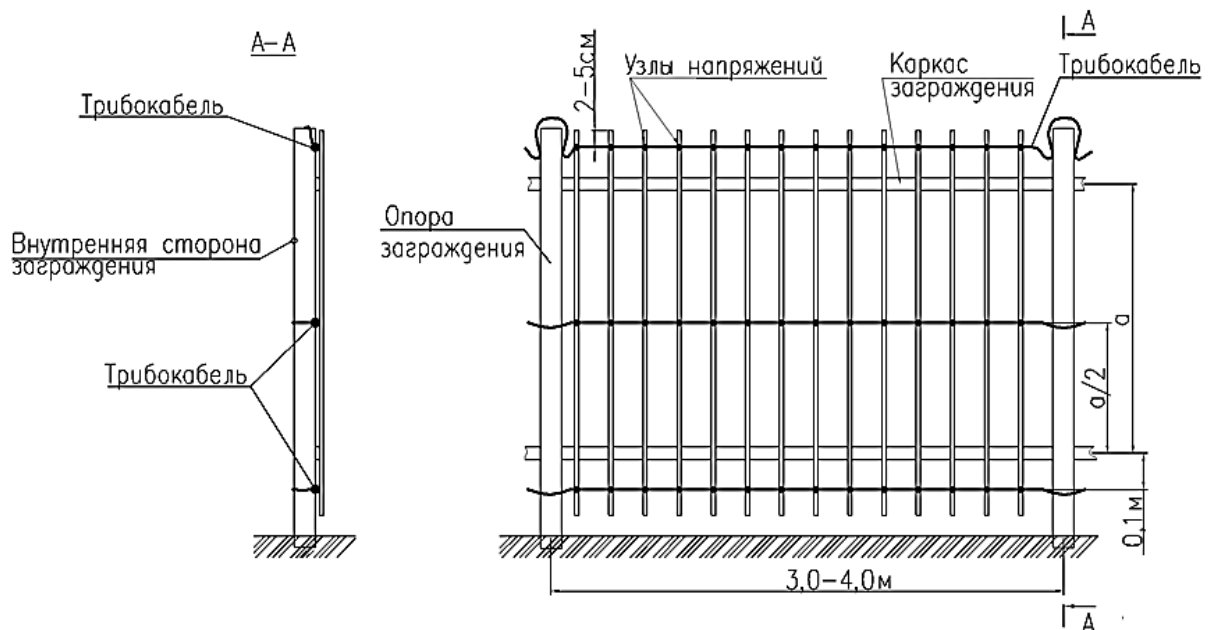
Оборудование ограждения из сварных (кованых) решеток
